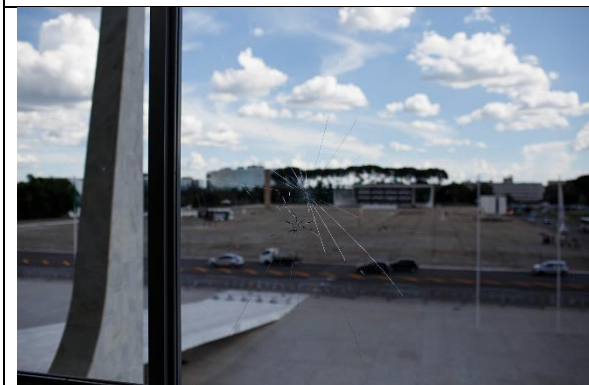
Fachada envidraçada do 2º pavimento ainda com danos (trinco). A substituição está prevista
